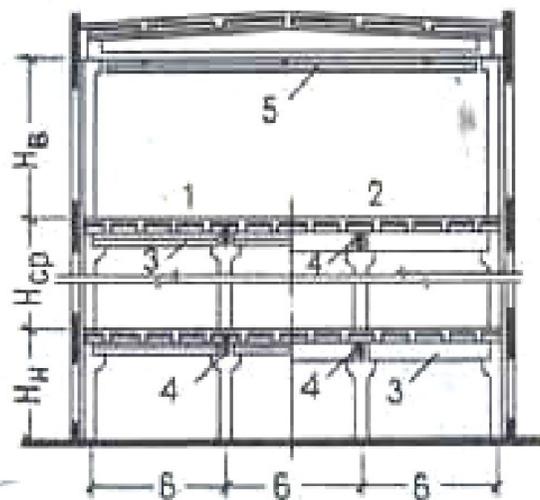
Конструктивные схемы многоэтажных промышленных зданий с балочными конструкциями перекрытий
